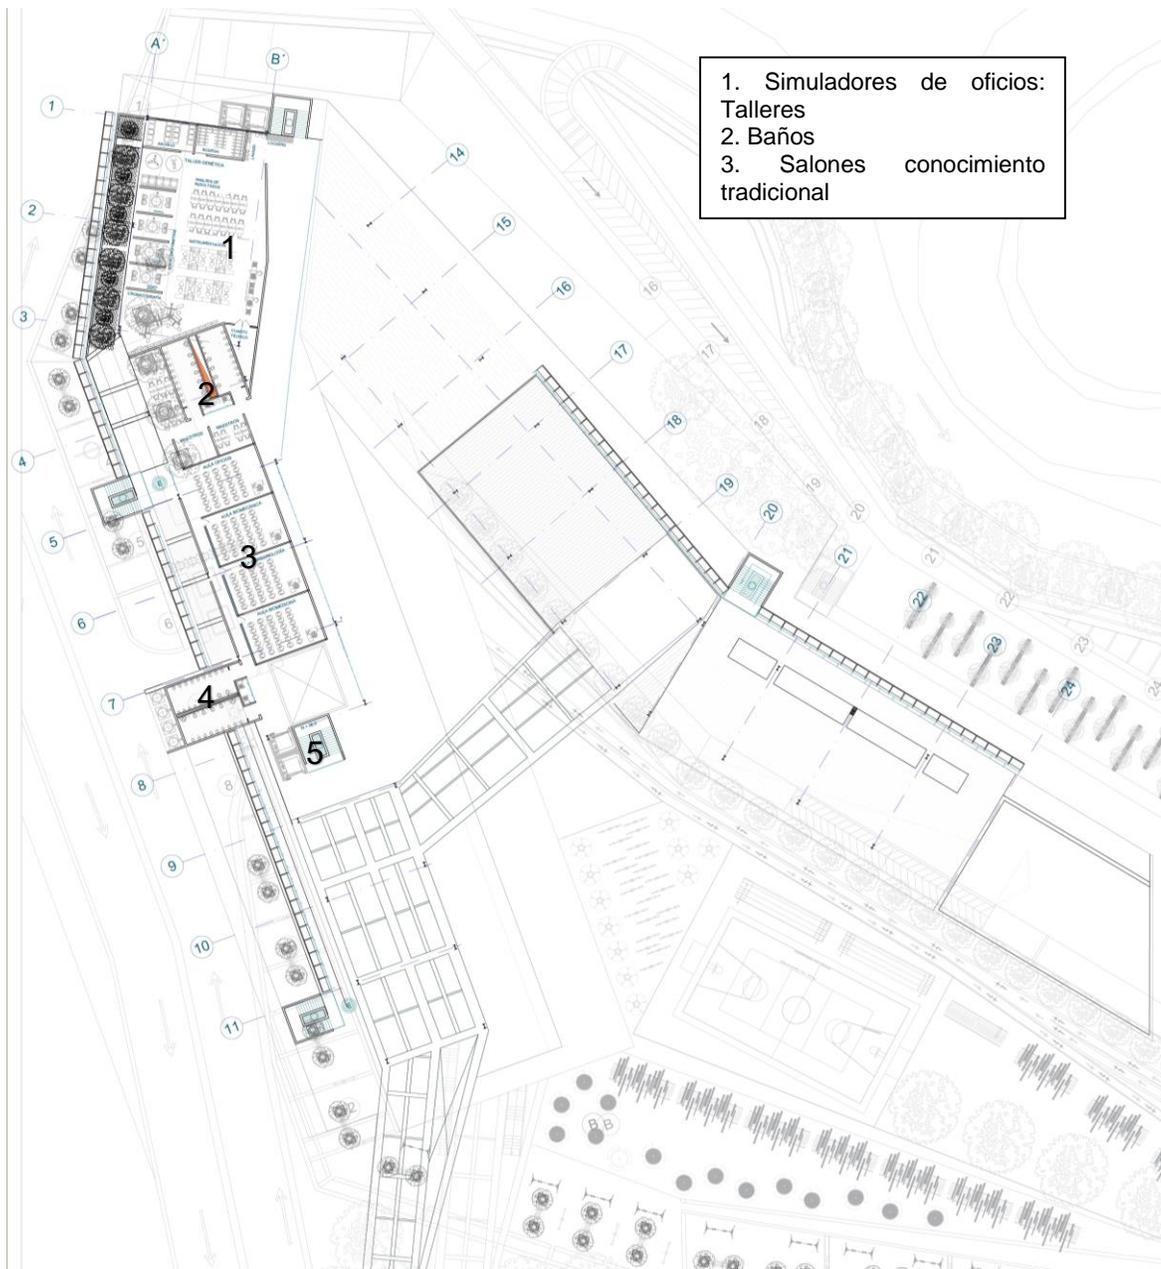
Planta arquitectónicas 5 y 6 niveles
